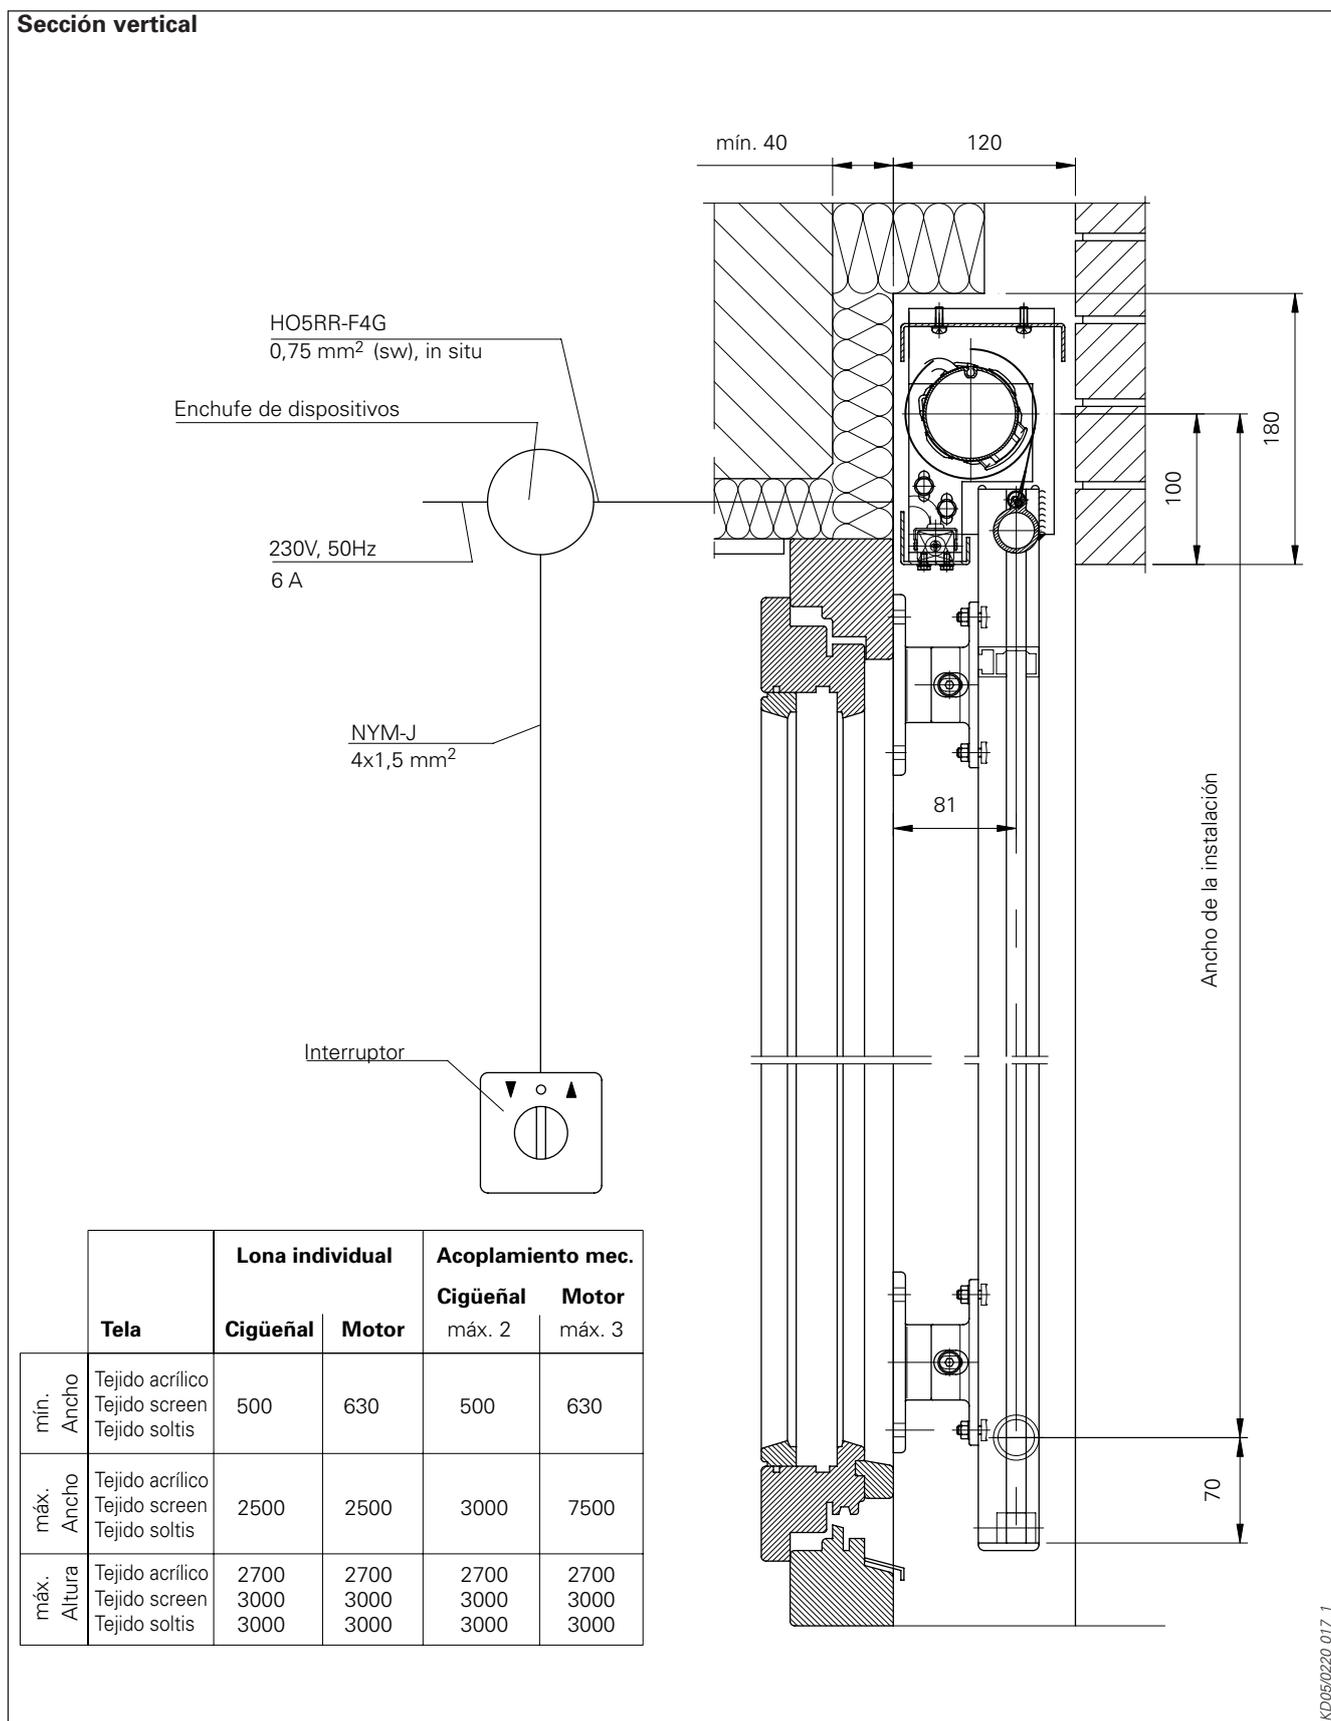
Sección vertical toldo para fachada Modelo 209 E con carril en C 20/40 en hueco in situ
